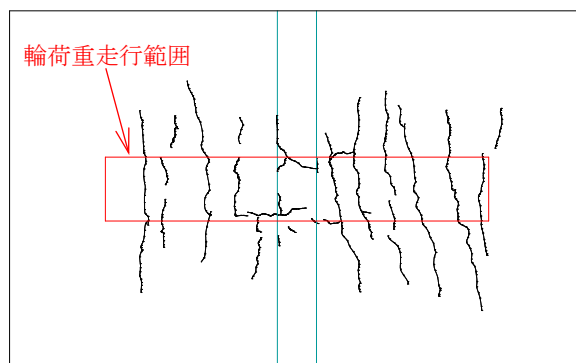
Step 1 終了時の床版下面ひび割れ図
